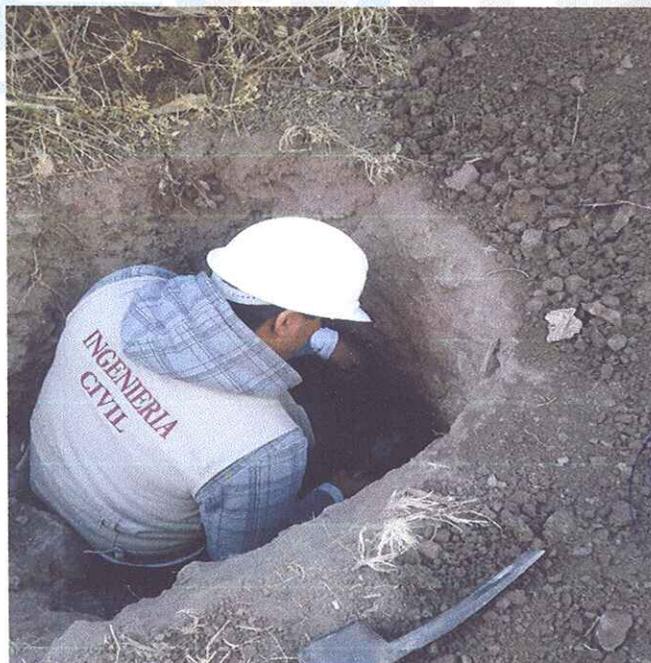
En la toma se aprecia una vista donde se extrae las muestras del lugar donde se excavo la Calicata C-01. Para luego procesar en laboratorio
